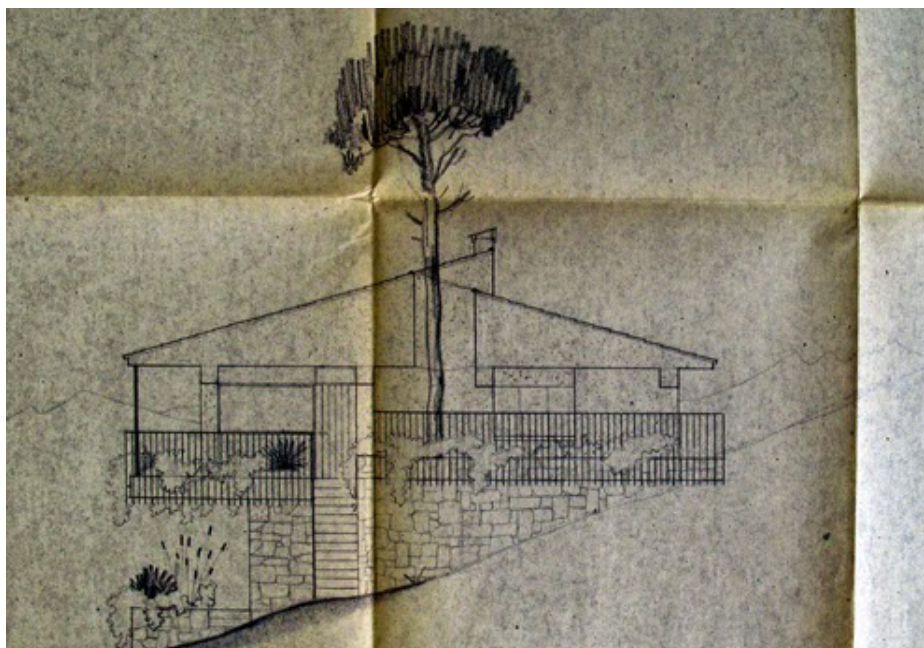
1.5 Alzado Sur de la Casa César Manrique.
